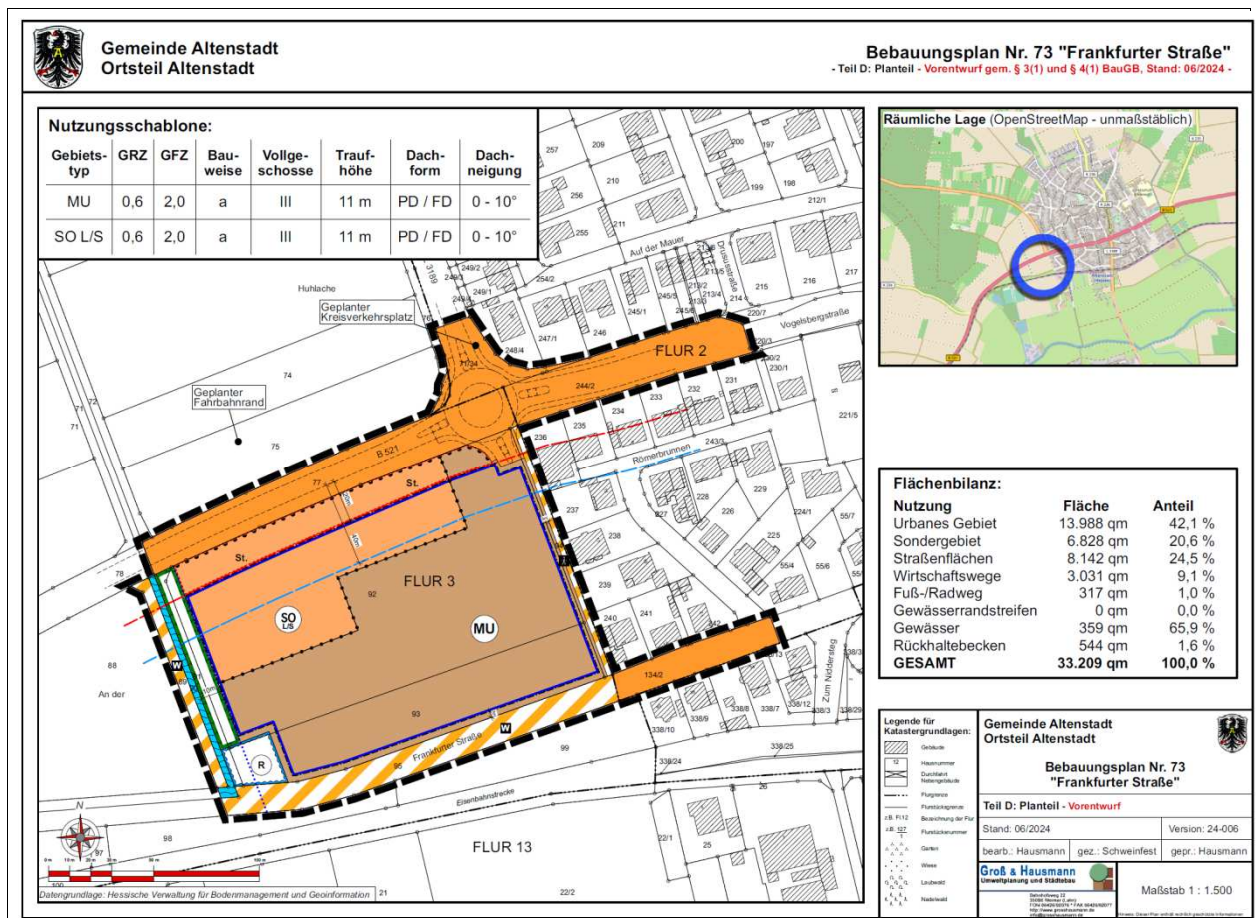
Bebauungsplan Nr. 73 „Frankfurter Straße“, Planteil, Vorentwurf.
